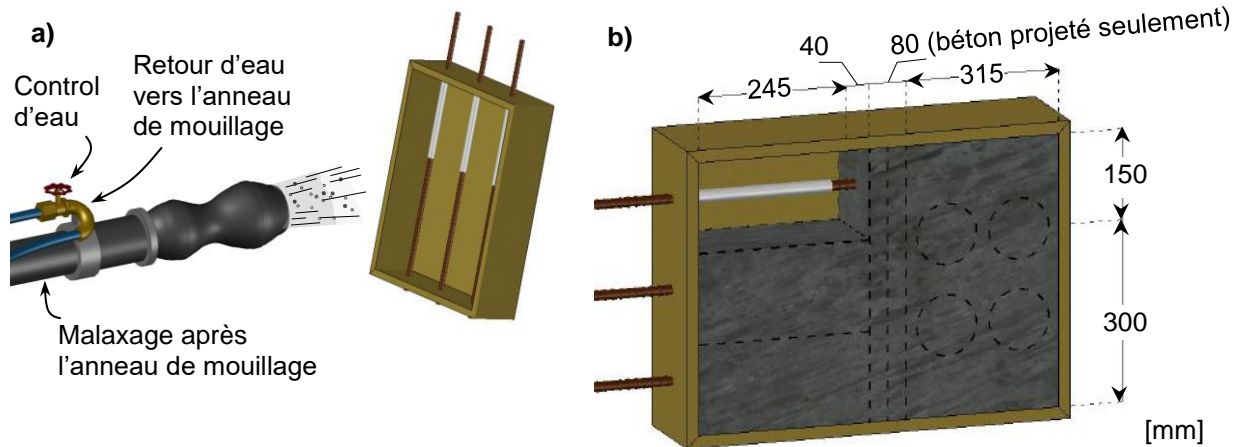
(a) Représentation de la projection et (b) dimensions des éprouvettes dans le moule
